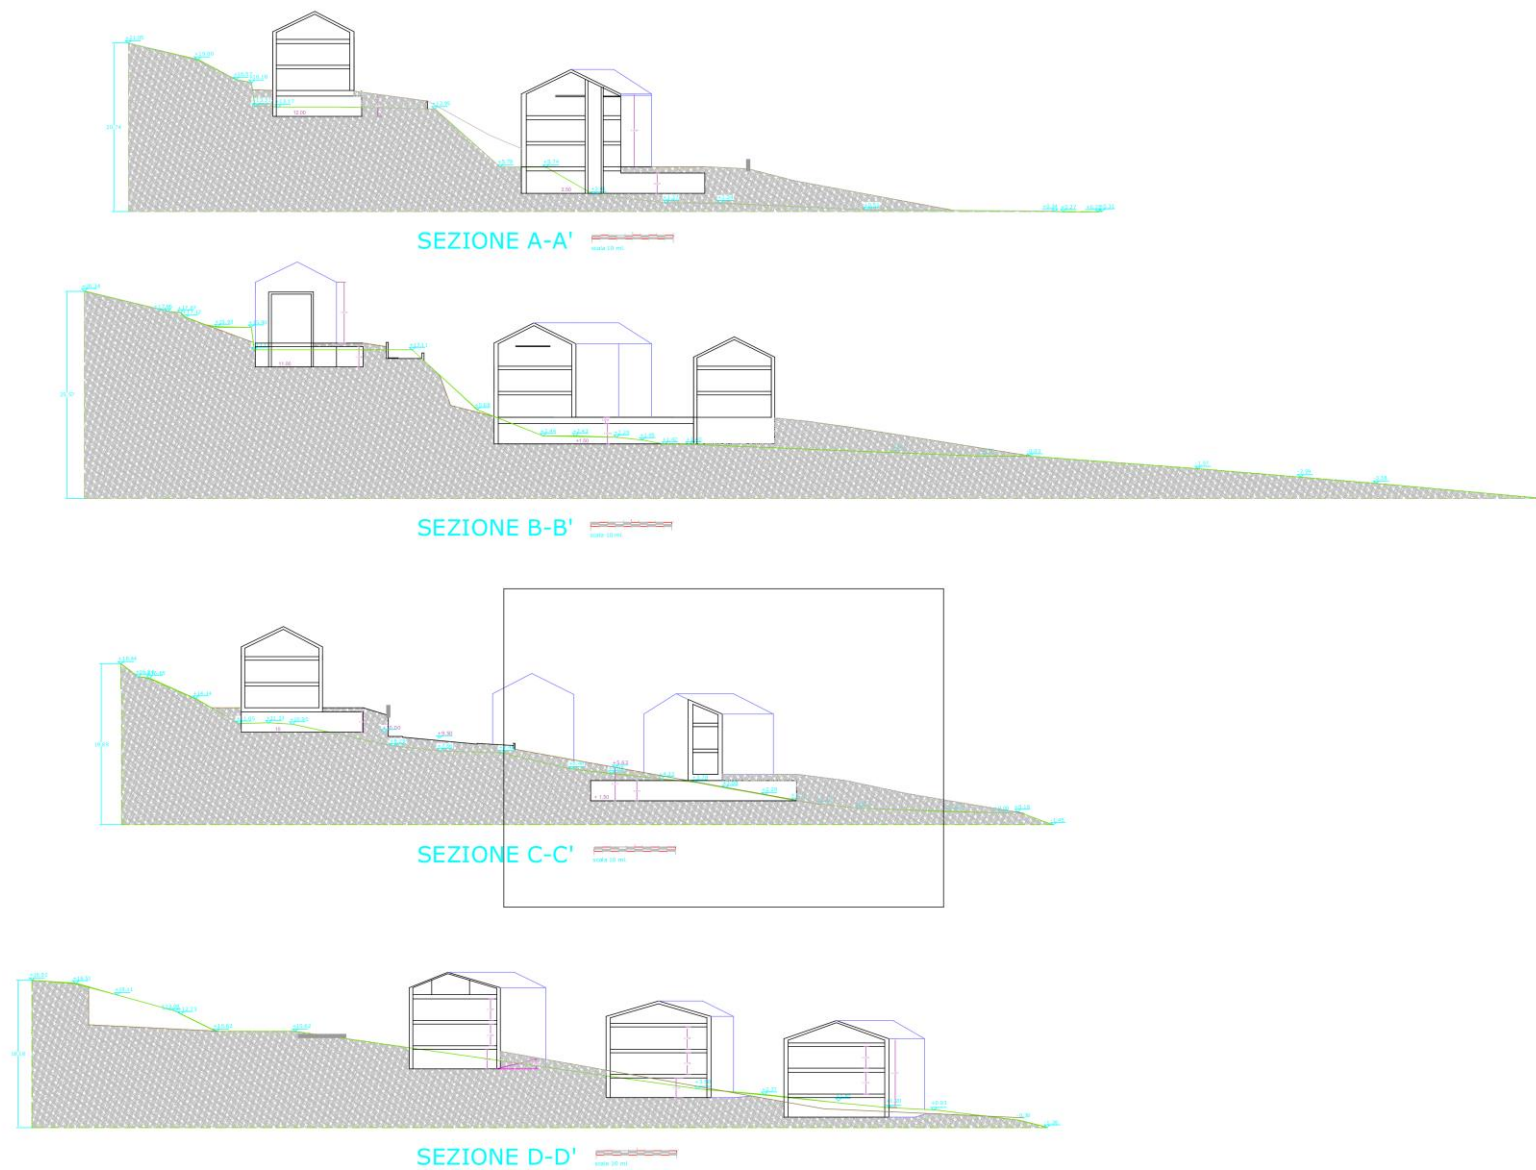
Tavola 1: Elaborato di progetto – sezioni
